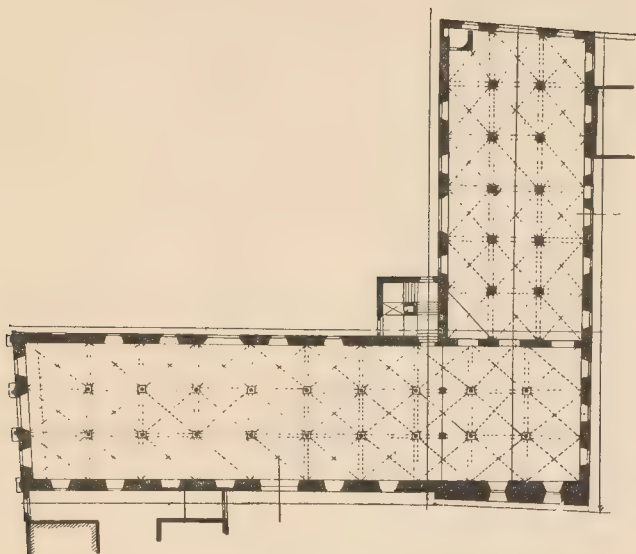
Zeughaus. Grundriß des Erdgeschosses.
